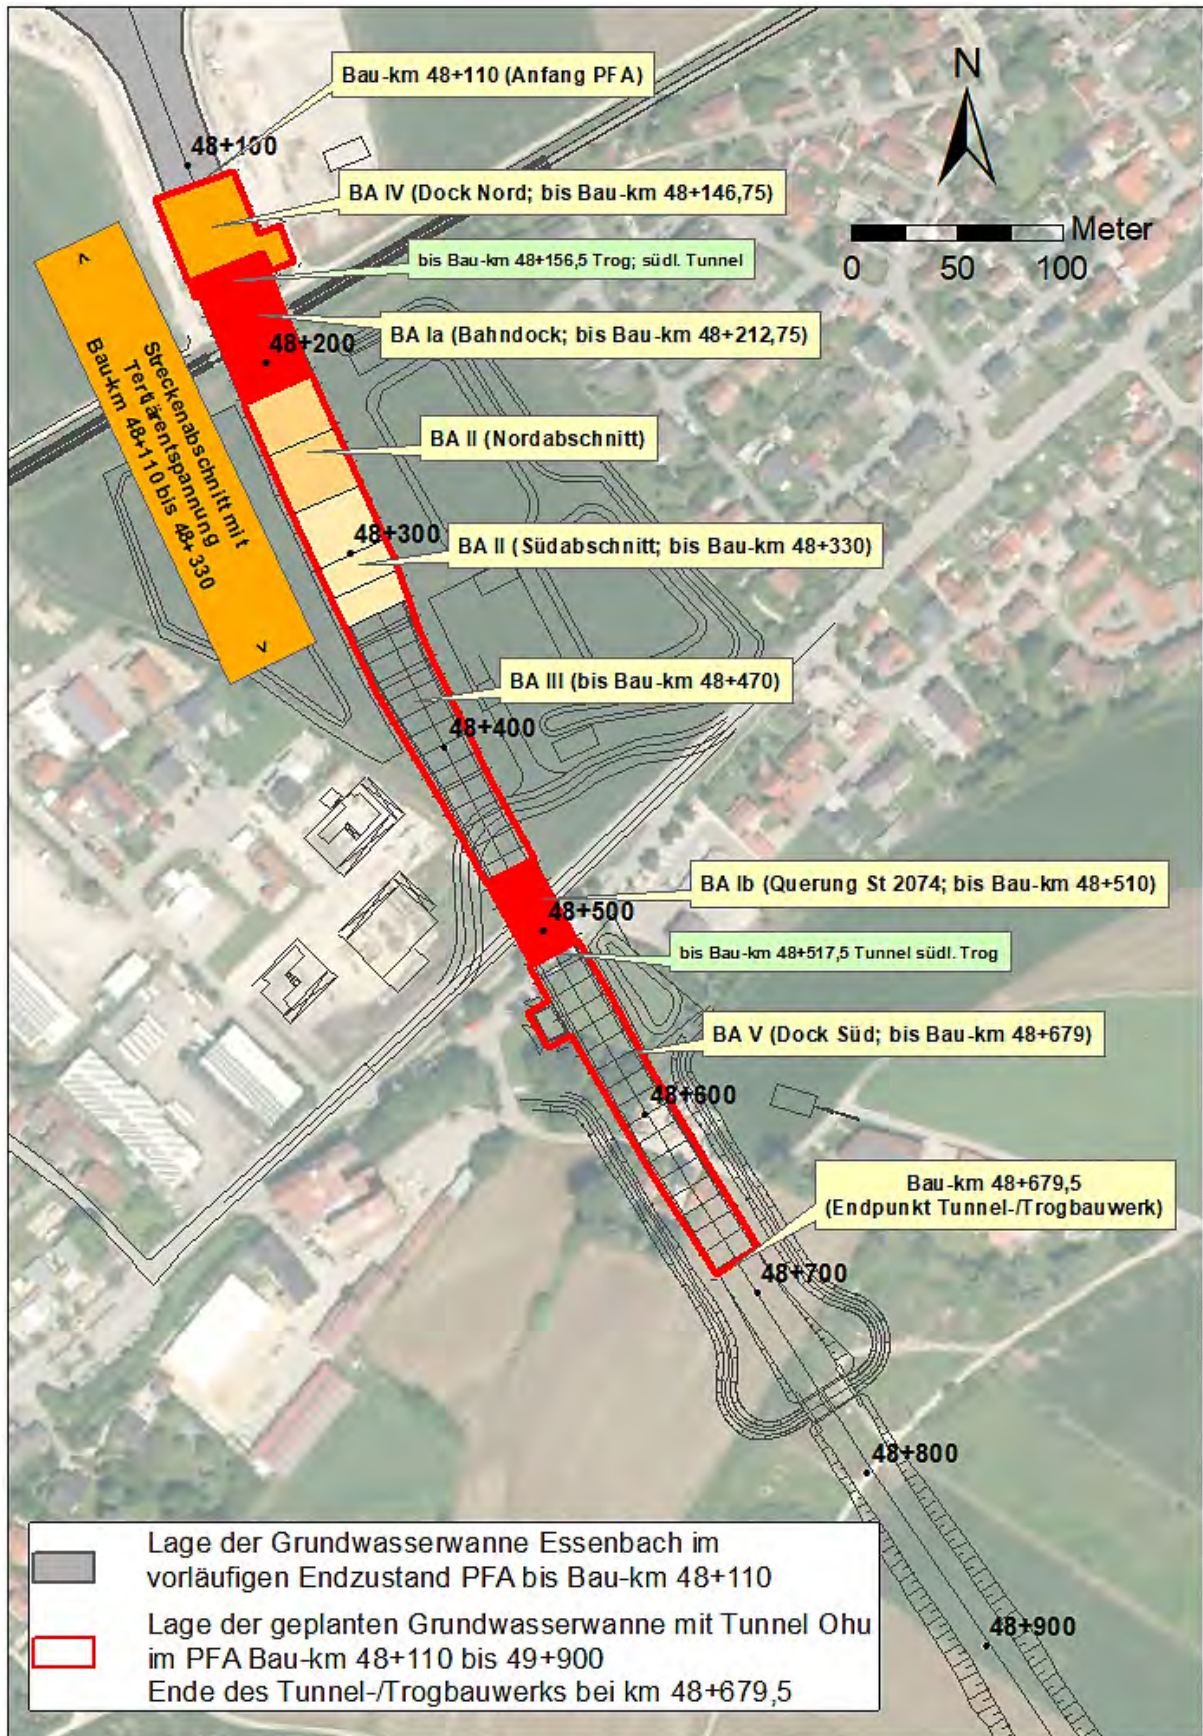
Übersicht des PFA mit Bauabschnitten und Bau-Kilometrierung
